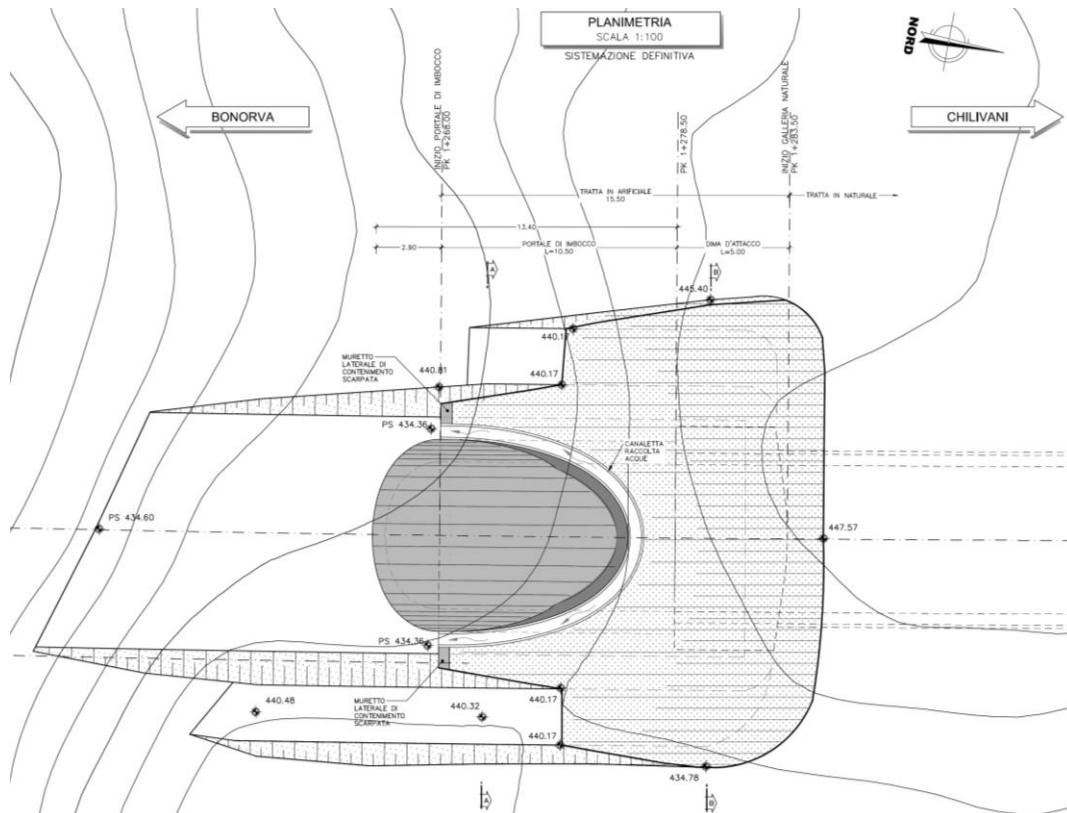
Galleria Monte Martis – Imbocco lato Bonorva – Planimetria in fase definitiva
